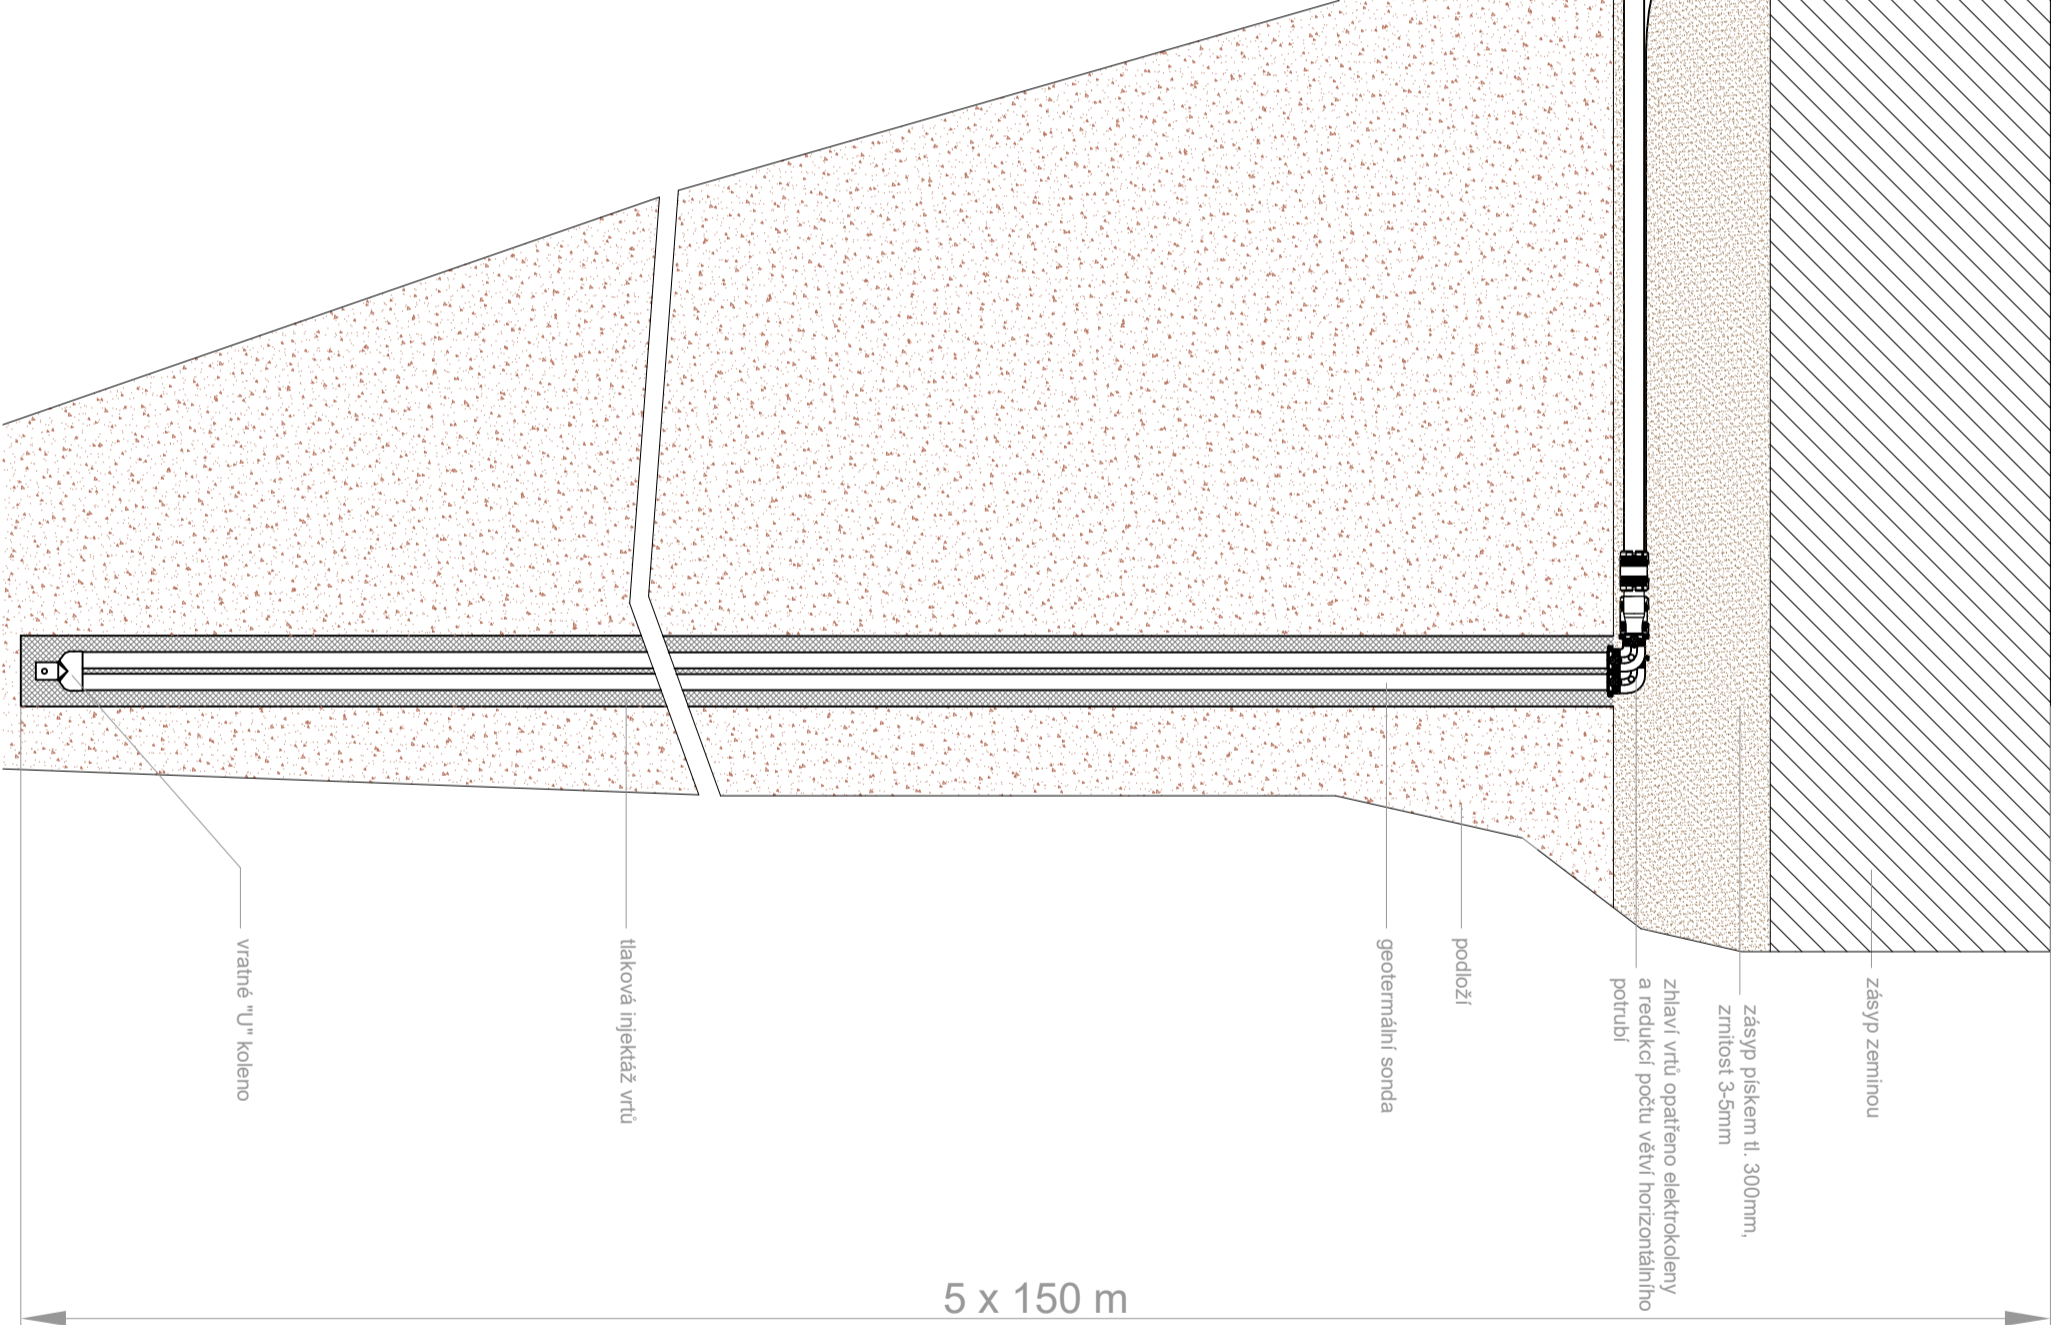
DETAIL SNIŽENÍ POČTU VĚTVÍ PRIMÁRNÍHO OKRUHU
